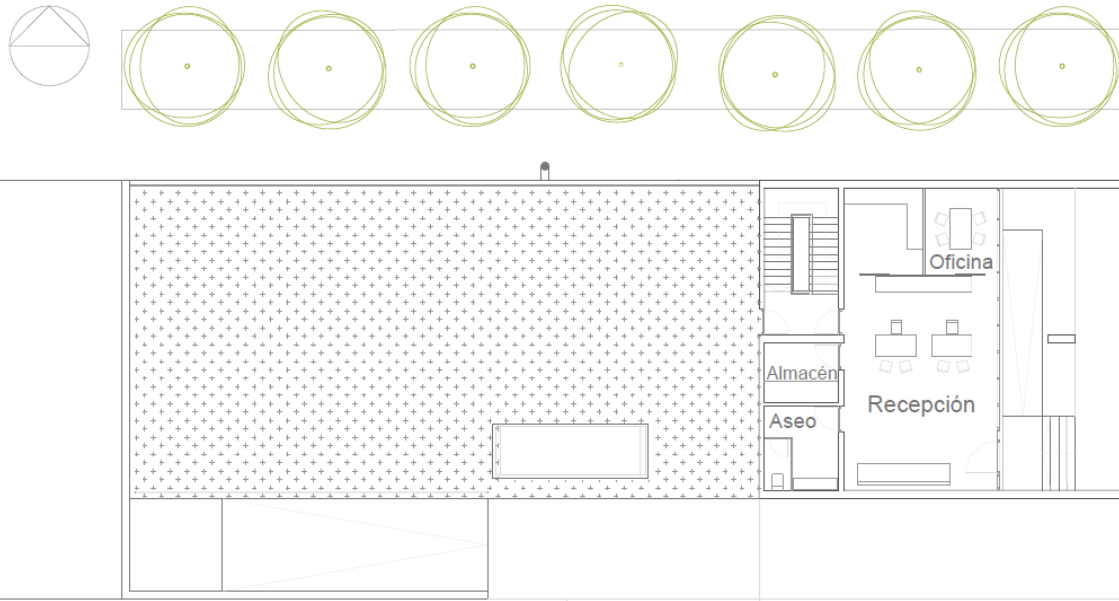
Planta primera, oficina y recepción. Fuente: *Elaboración propia.
